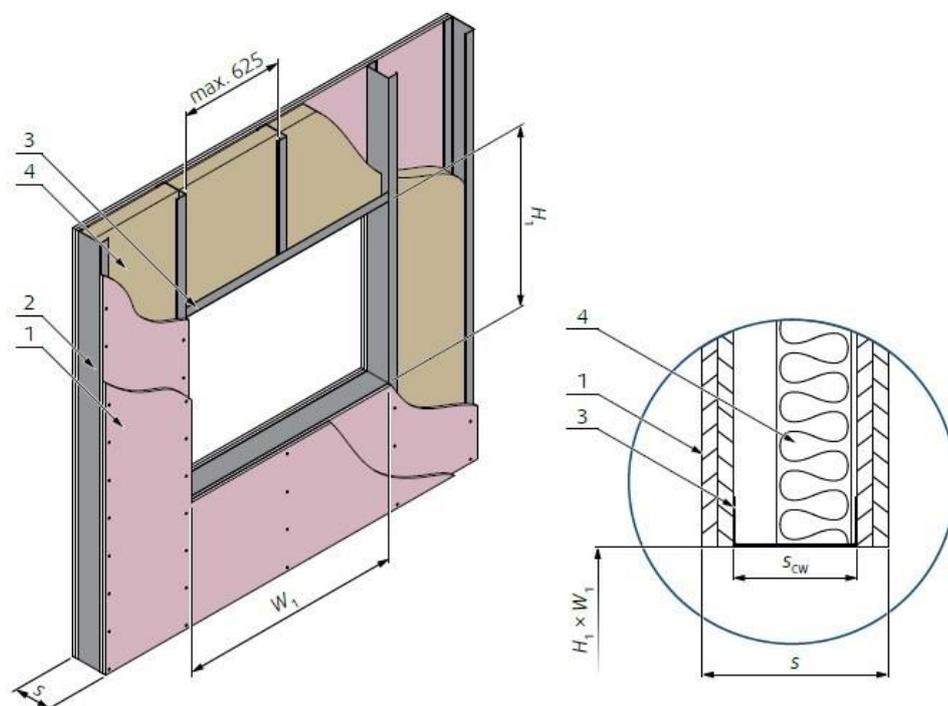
Parete flessibile in cartongesso con apertura rettangolare (a sinistra) e sezione trasversale verticale (a destra)
